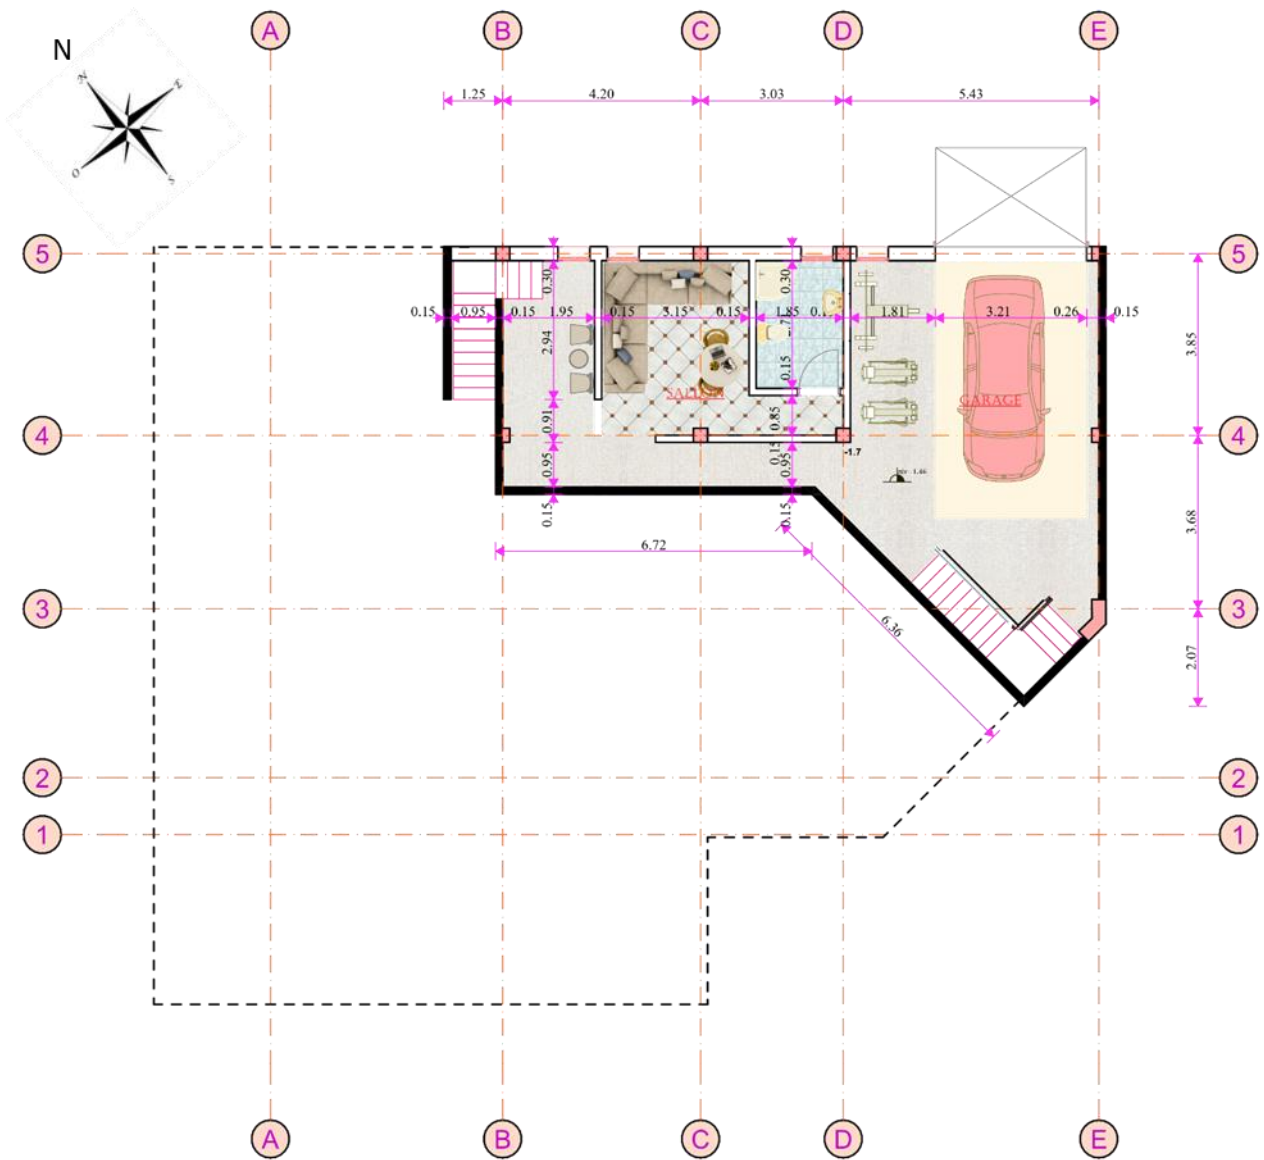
Plan Sous-Sol F5 ech 1/100.
